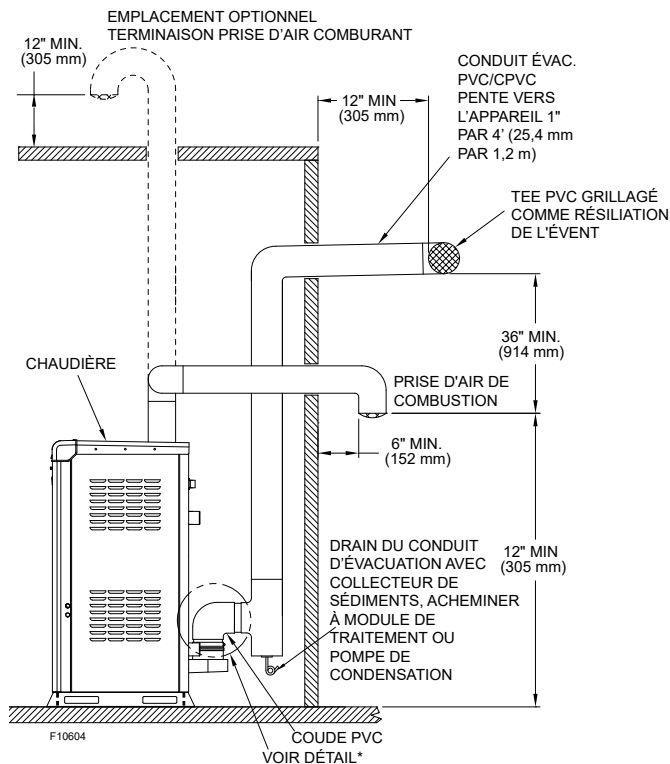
Détails de l'assemblage en PVC - Installation au chantier
